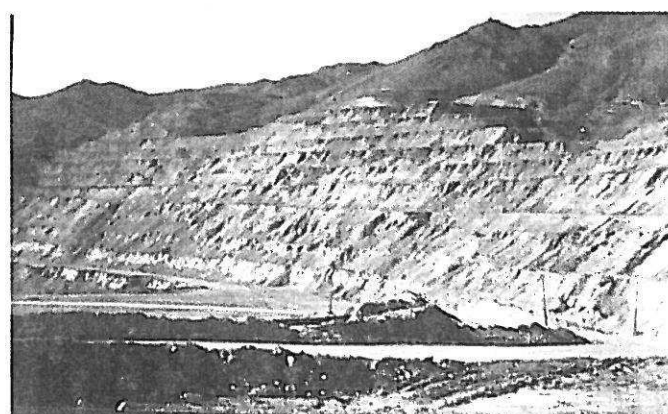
Flanc SW de la mine de Sar Cheshmeh, NICICO. Vue d'ensemble.
